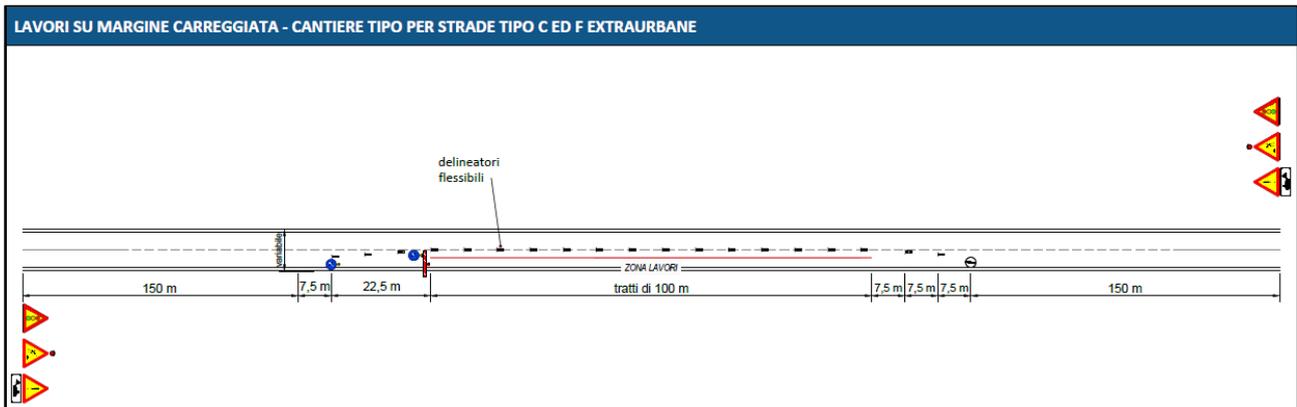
Schema tipo di organizzazione del cantiere per la posa del cavidotto interrato su strada
